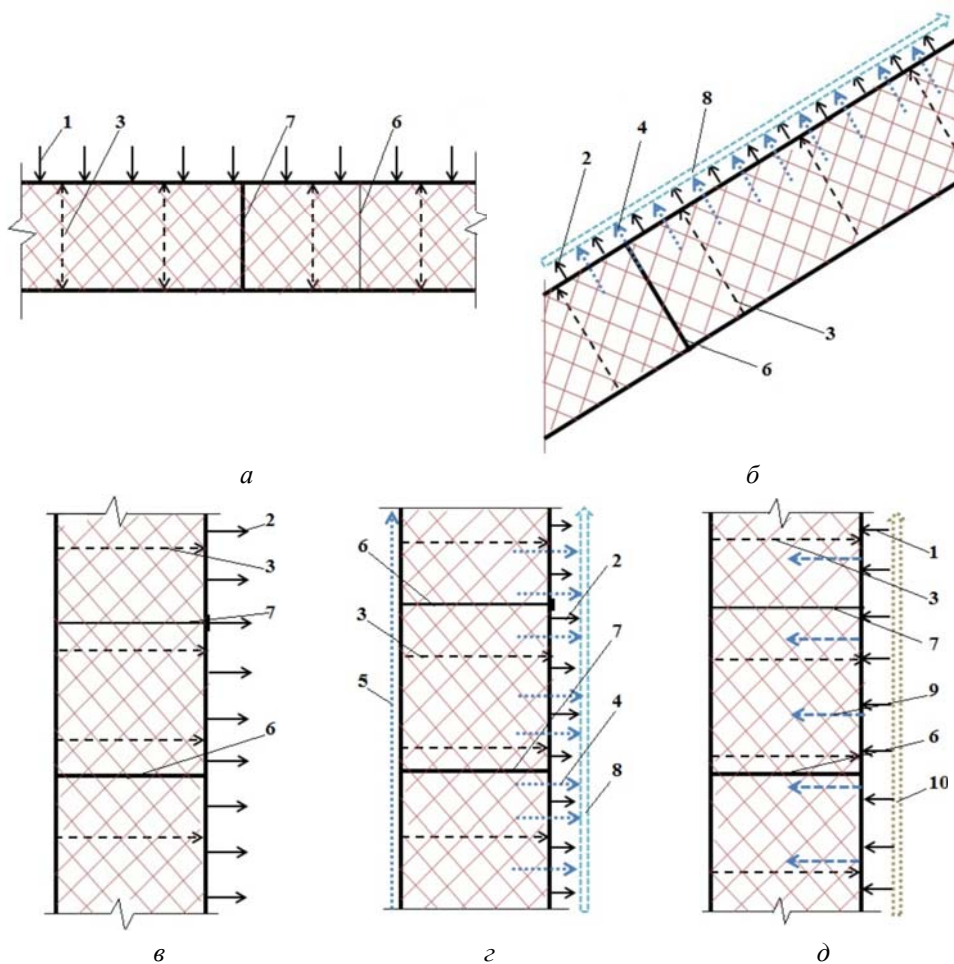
Нагрузки на теплоизоляцию: а — плоская кровля; б — скатная кровля; в — штукатурный фасад; г — вентилируемый фасад; д — стена эксплуатируемого подвала: 1 — сжимающие усилия (распределенные); 2 — усилия на отрыв (распределенные); 3 — естественная конвекция воздуха и паров воды в утеплителе; 4 — вынужденная конвекция воздуха; 5 — конвективные потоки воздуха вдоль стены; 6 — фильтрация воздуха (и паровоздушной смеси) на примыканиях плит; 7 — механическое воздействие от крепежа; 8 — движение воздуха в вентилируемом зазоре; 9 — проникновение капельной влаги; 10 — сдвиговые усилия в грунте
